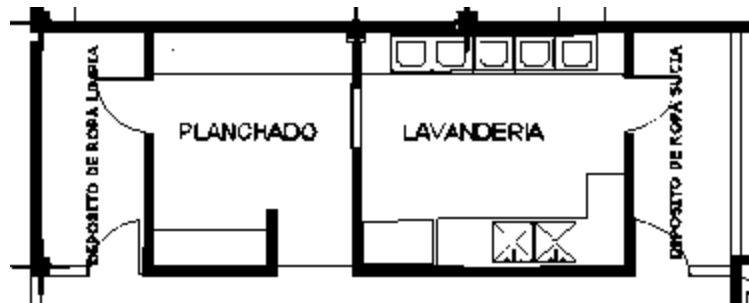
area de estudio. Fuente: Plano arquitectónico del proyecto
